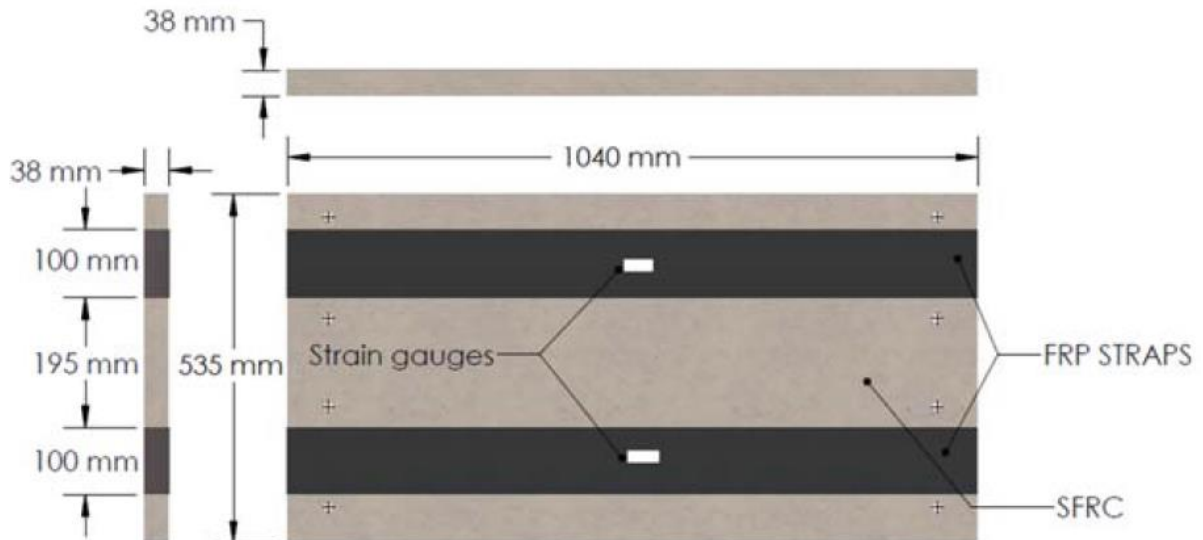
Dimensiones de los paneles [Beirnes, M.J., R.G. Wight, M.A. Dagenais (2019)]
